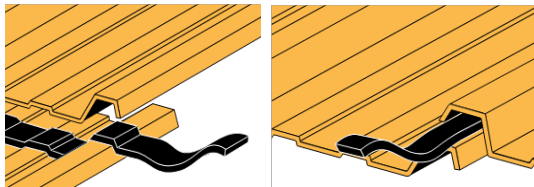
Exemples de recouvrement transversal et longitudinal sur couverture métallique nervurée
